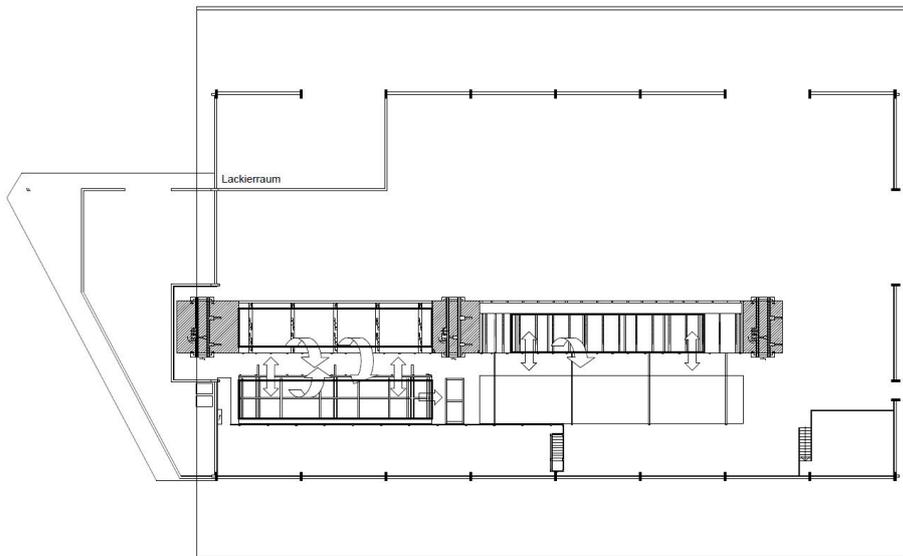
Grundriss Betriebshalle 2 (Projekt A)⁴⁴⁷
